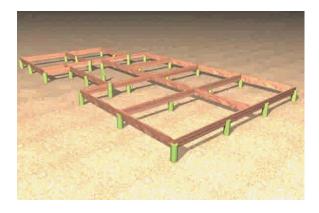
15: Vigas friso (viga perimetral) y vigas principales (vigas interiores) que unen las cabezas de los pilotes y transfieren las diferentes cargas de la estructura de la vivienda a la fundación aislada.
